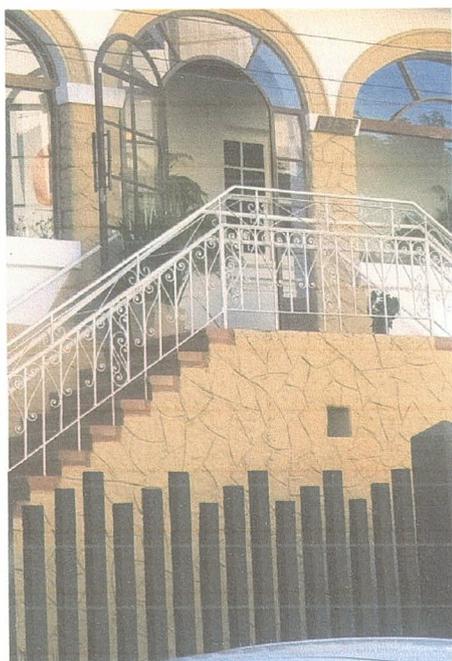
e 03 - Vista parcial do muro da fachada Rua Pio XII
